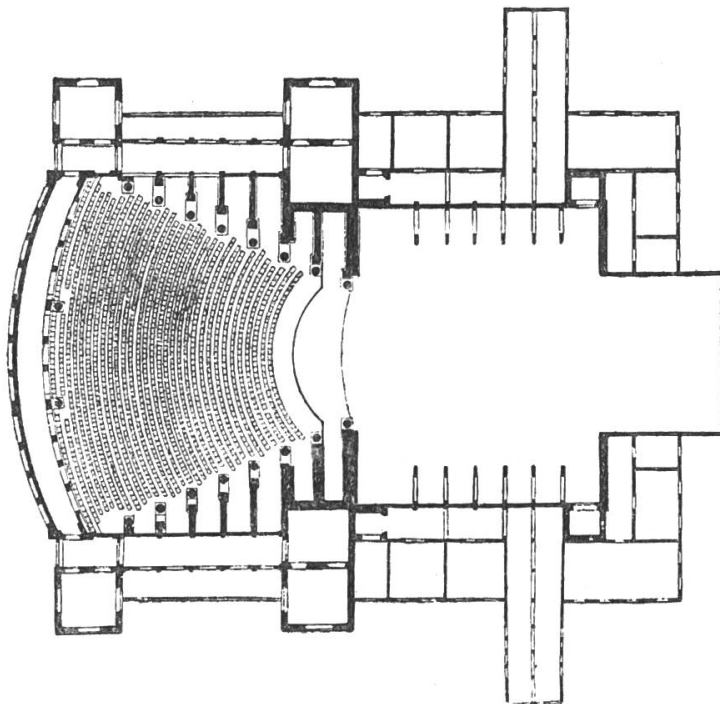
Festspielhaus in Bayreuth. Grundriss.
